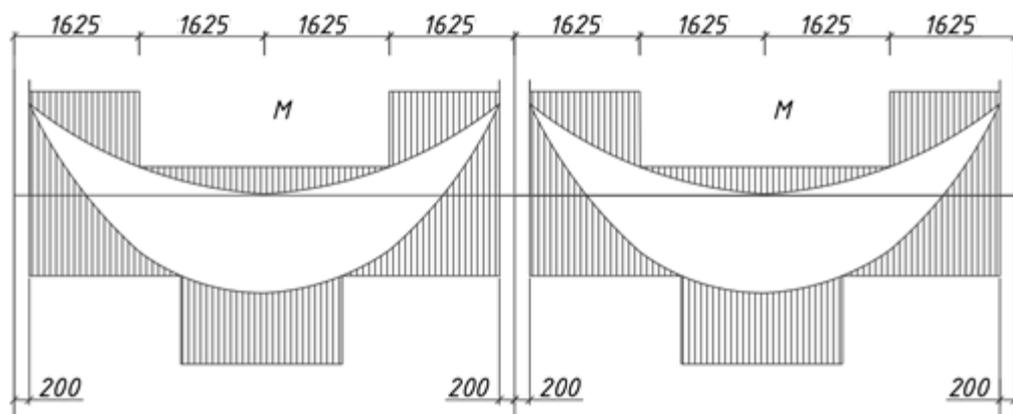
Схема фрагмента монолитной плиты перекрытия в осях 4-5 и рядах Б-В с опирание на колонны при определении действующих факторовв
